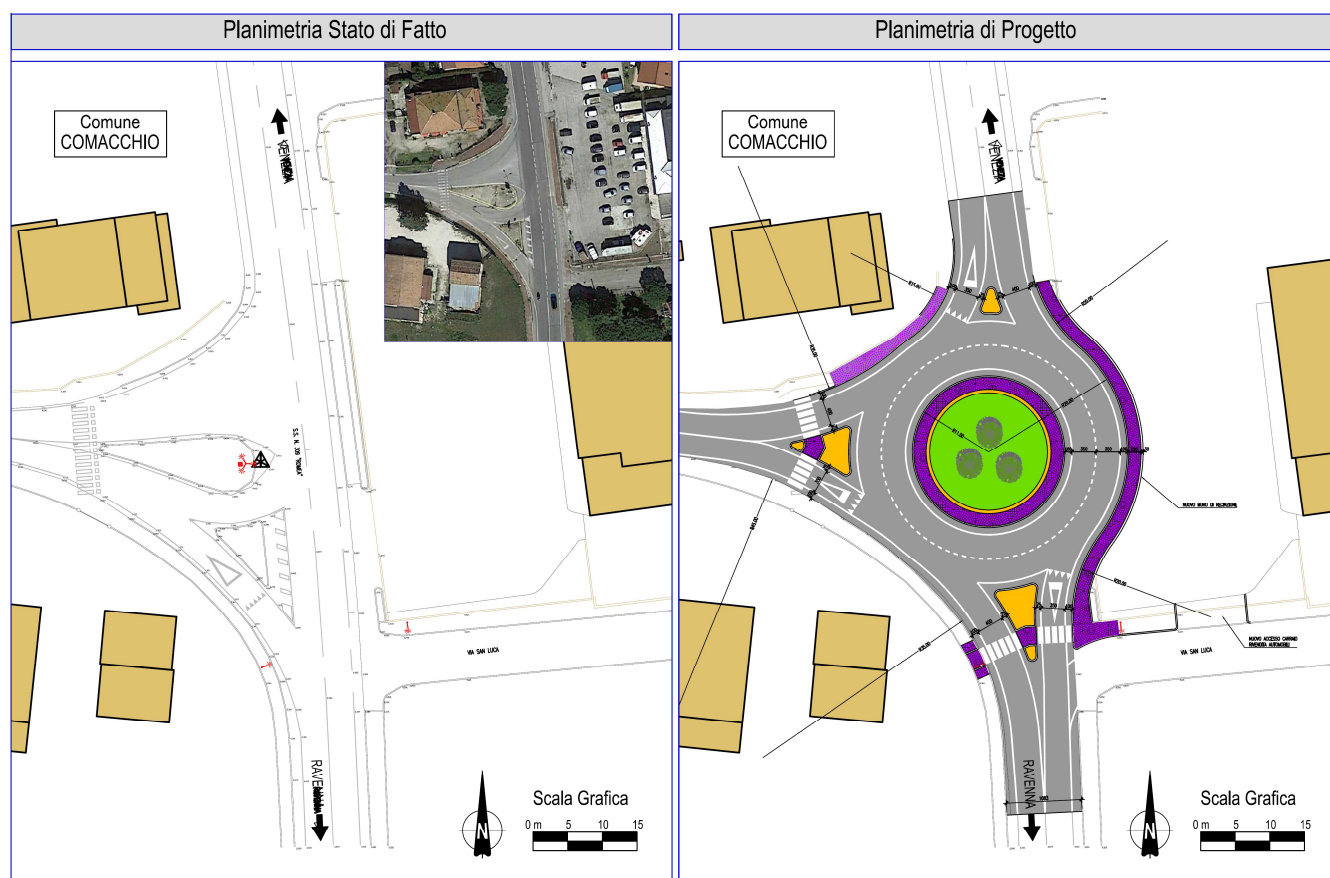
Intervento n°16 – Planimetria Stato di fatto - Progetto
